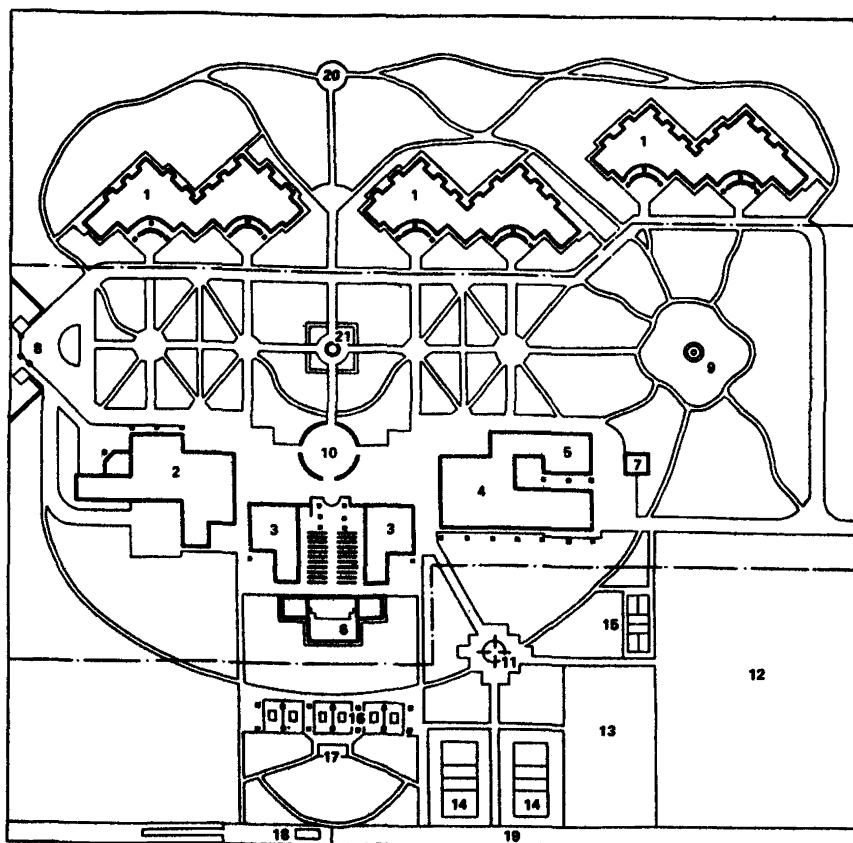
Схема генерального плана ЛТО на 240 мест (на примере ЛТО на 240 мест агро-промышленного комплекса "Кубань" в Краснодарском крае)
